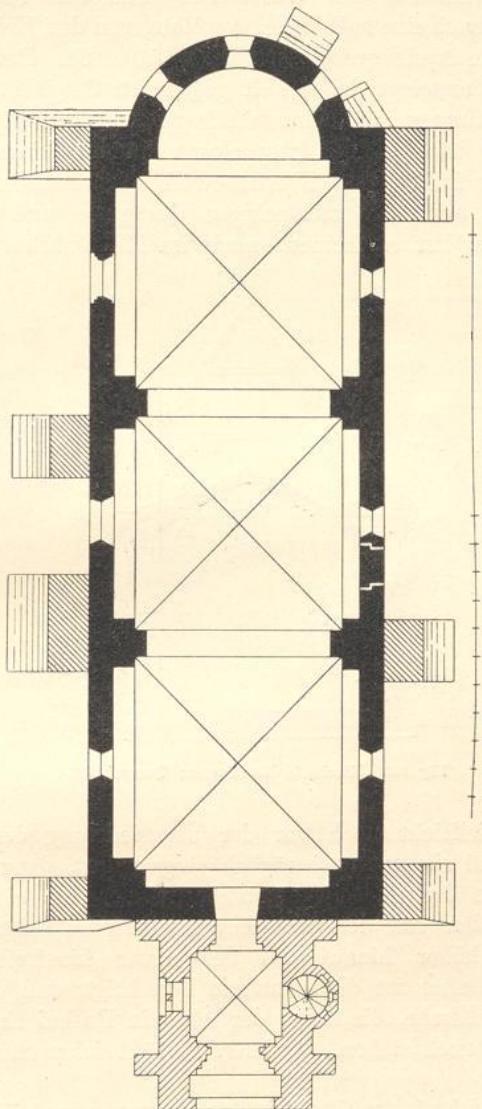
Kirche in Heeslingen; Grundriss.
